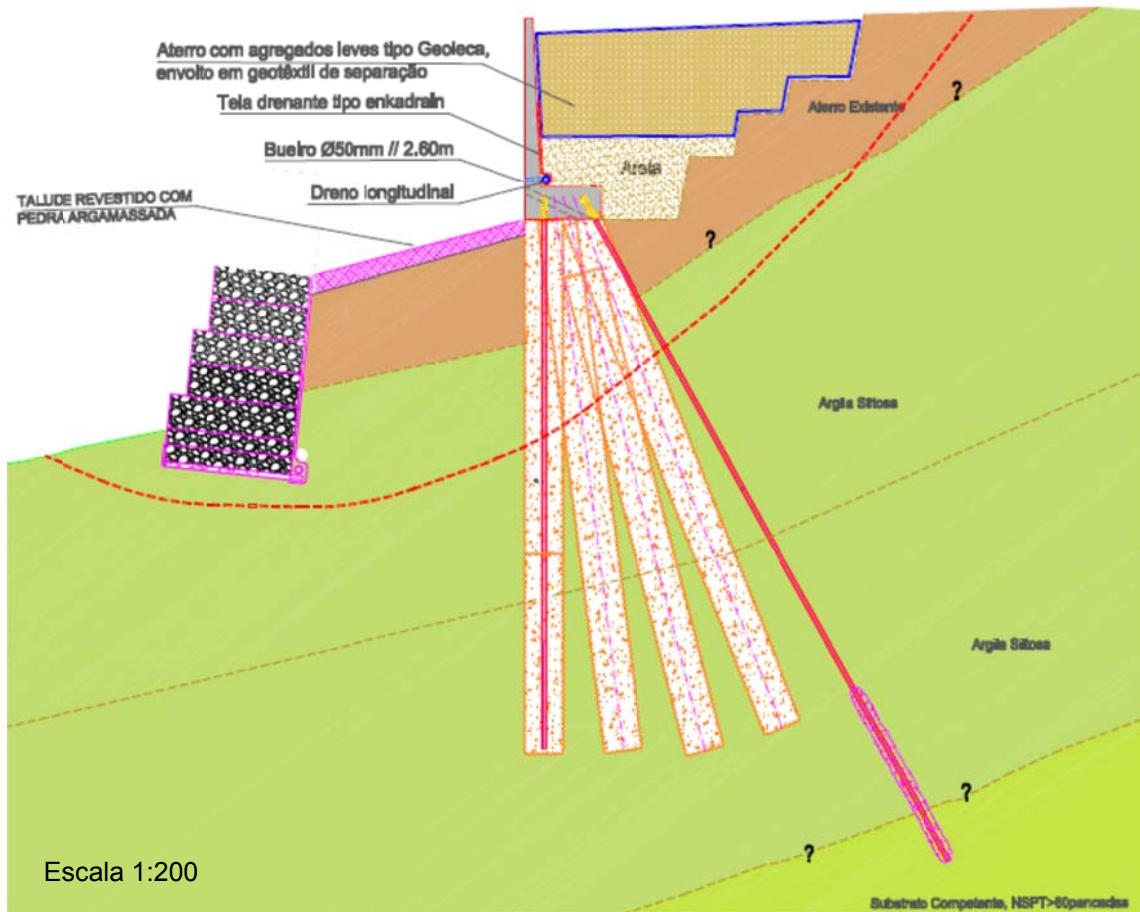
4ª Fase: Execução do muro de betão armado, do aterro e reperfilamento do talude [3].
